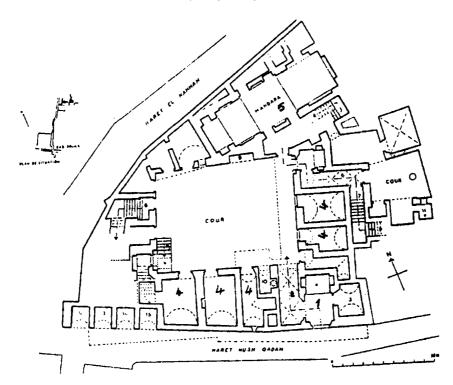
مسقط أفقي لمقعد منزل الكريدلية .
